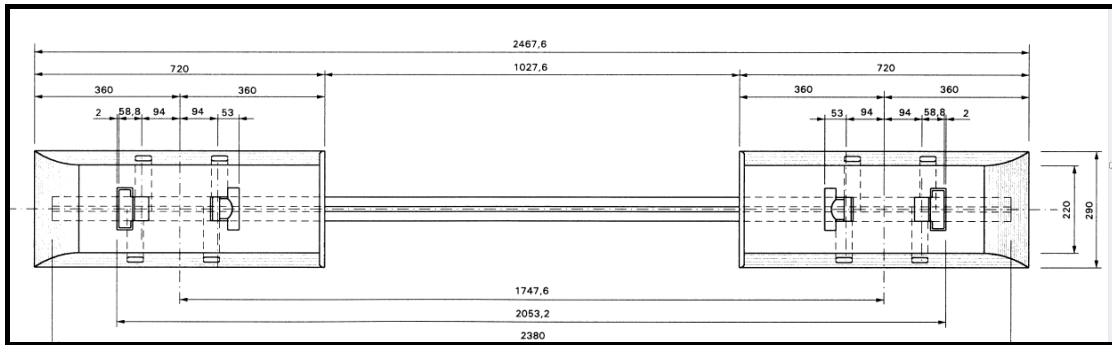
Travesía bloque tipo RS para carril de 45.
